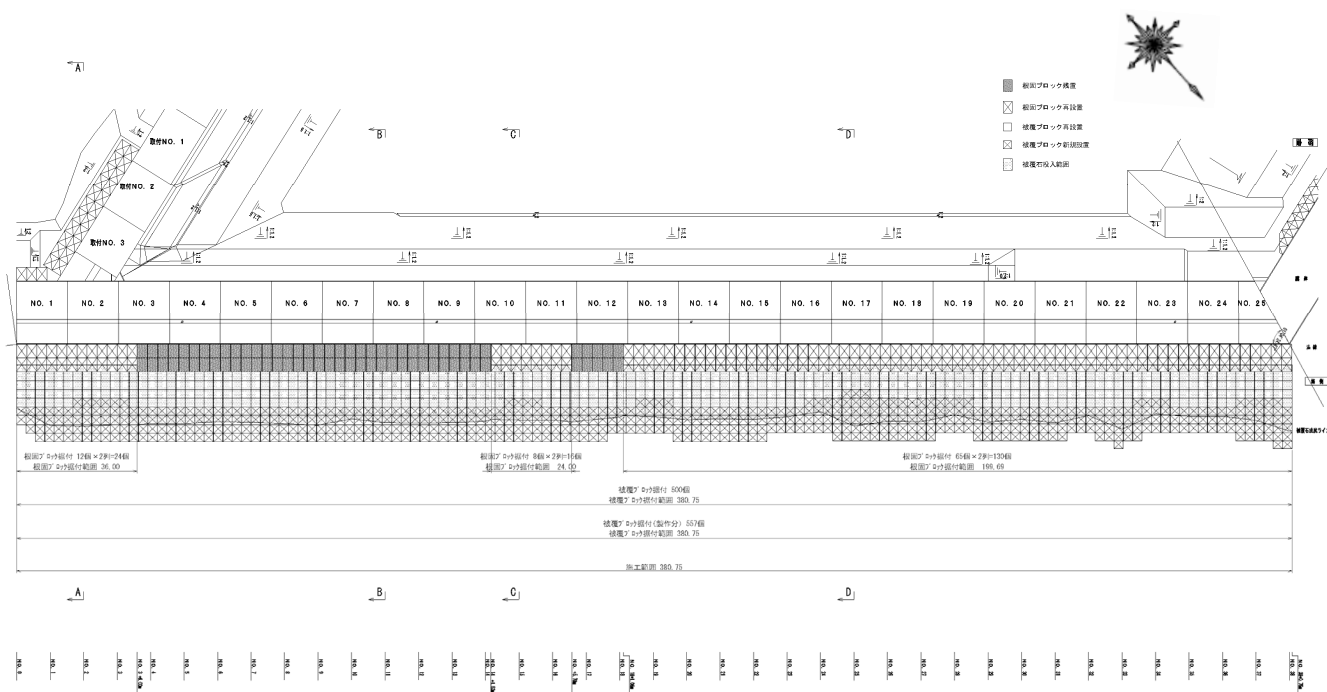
No.1 外港地区防波護岸平面図（復旧後）_復旧平面図（3）
